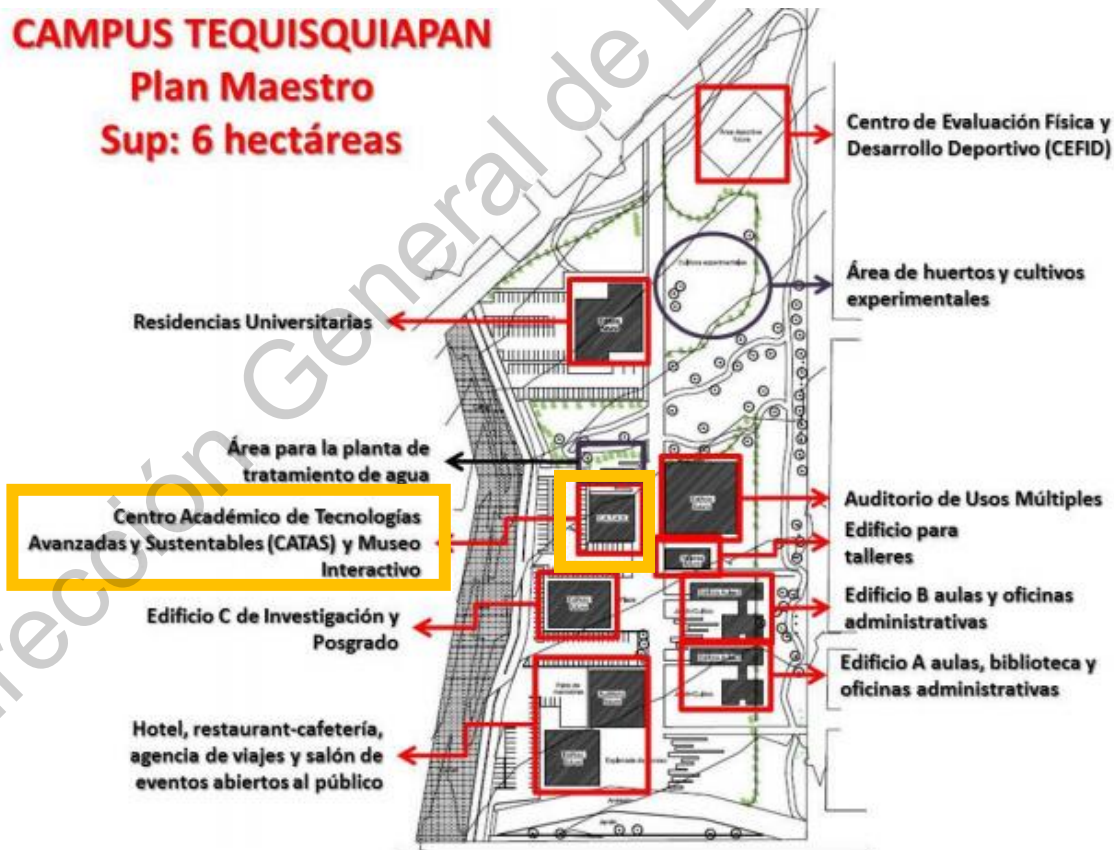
Plano Arquitectónico del Campus (Plan de desarrollo del campus Tequisquiapan, 2015).
